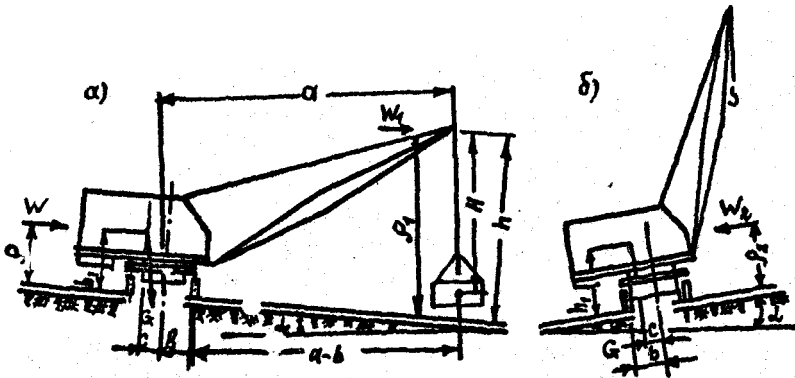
Расчетная схема устойчивости самоходного крана: а - с грузом; б - без груза
